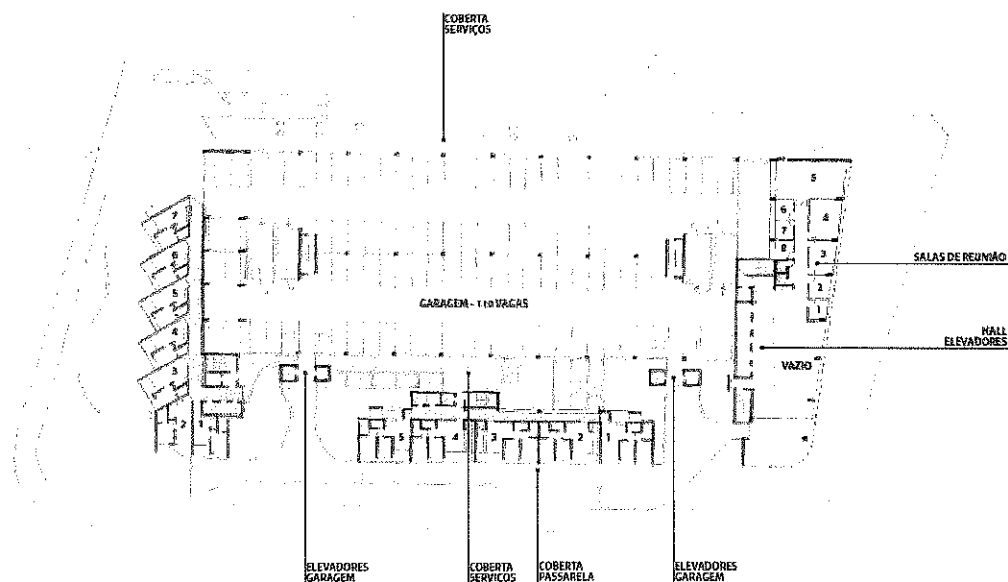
Planta Baixa do 1º pavimento da nova proposta. Fonte: Autor do Projeto
